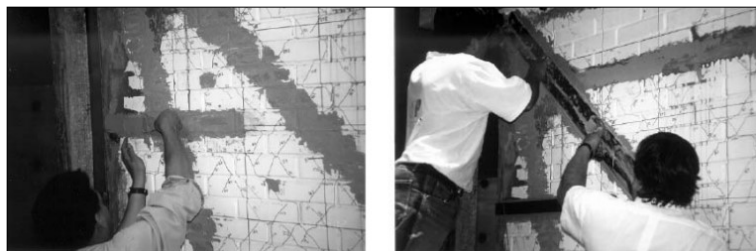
Fibras de carbón en paredes de mampostería confinada. (Tomada de Sociedad Mexicana de Ingeniería Estructural, “Rehabilitación sísmica de edificaciones de mampostería para vivienda”, Jorge Ruiz García, Queretaro 2007).
